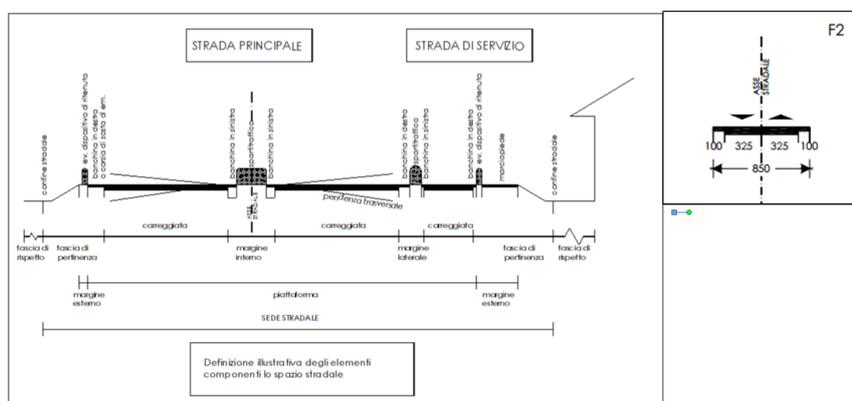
DEFINIZIONE ILLUSTRATIVA DEGLI ELEMENTI COMPONENTI LO SPAZIO STRADALE
